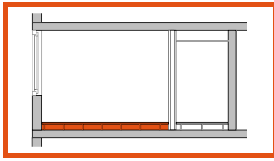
Fertigteildecke mit integriertem Lüftungssystem (Quelle: DW Systembau GmbH, BRESPA Lüftungsdecke).
